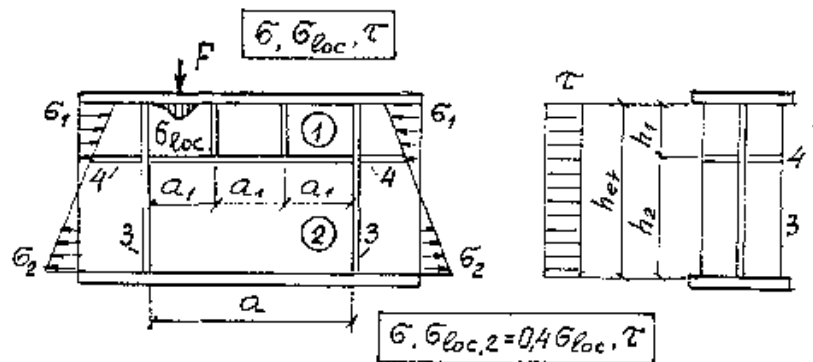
Схема балки, укріпленої поперечними (3), поздовжнім (4) і проміжними (5) ребрами жорсткості
